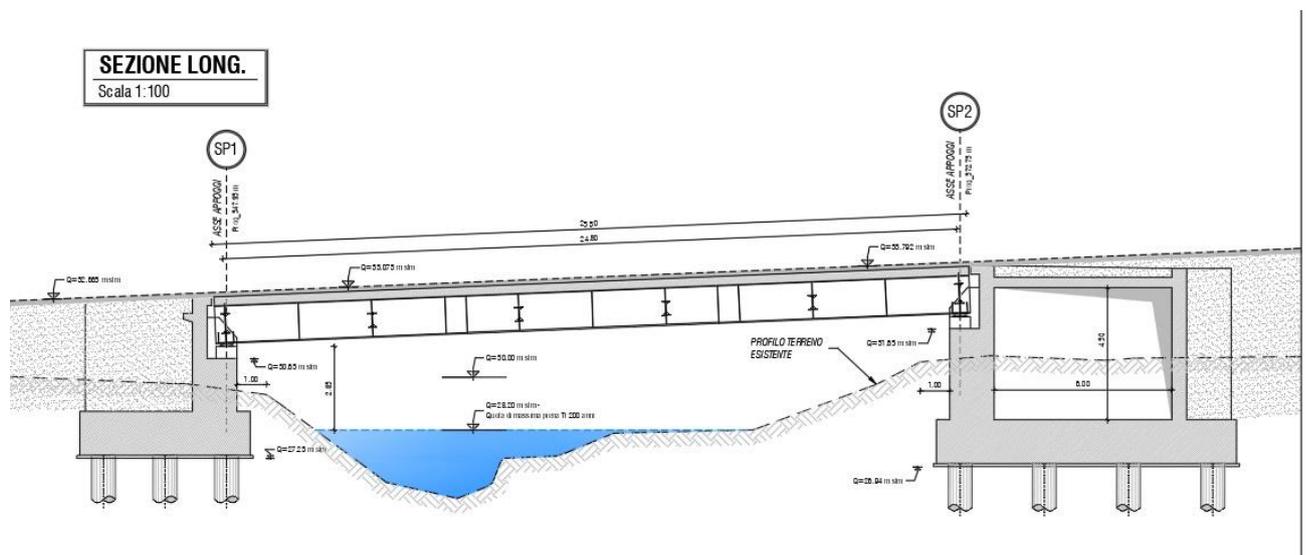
Sezione longitudinale Ponte P01- su Canal Magro
